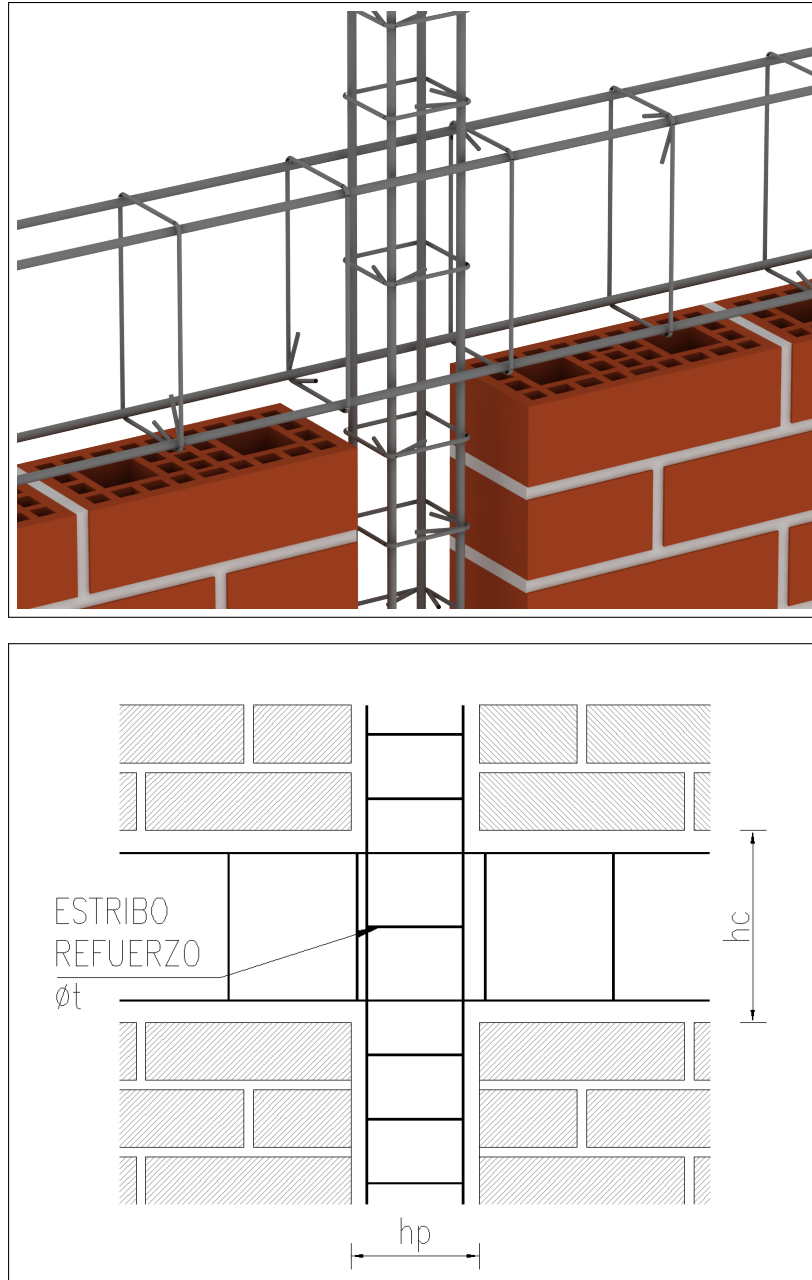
Detalle del refuerzo en la zona del nudo de encuentro cadena-pilar
